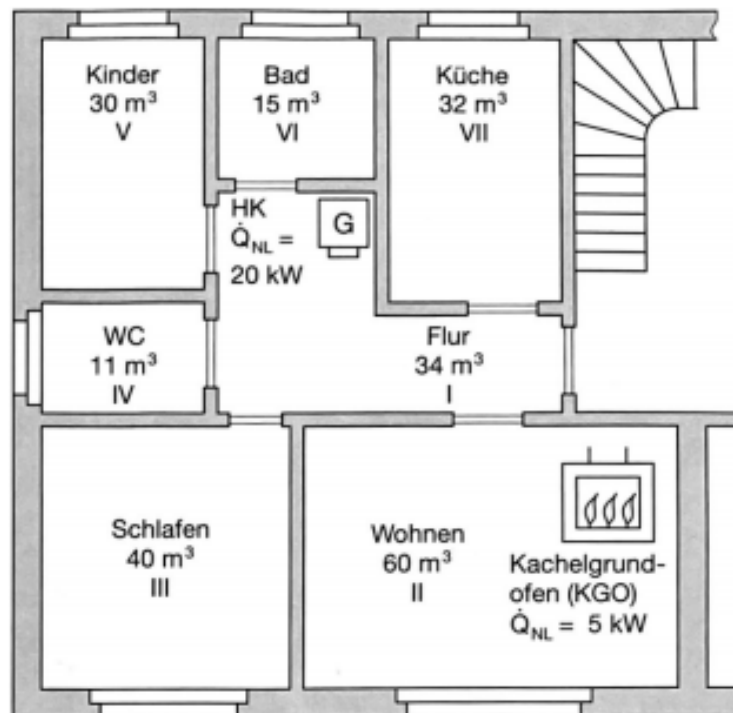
Grundriss zum Beispiel, ein Heizkessel (HK) 20 kW und ein Kachelgrundofen (KGO) Nennleistung 5 kW
